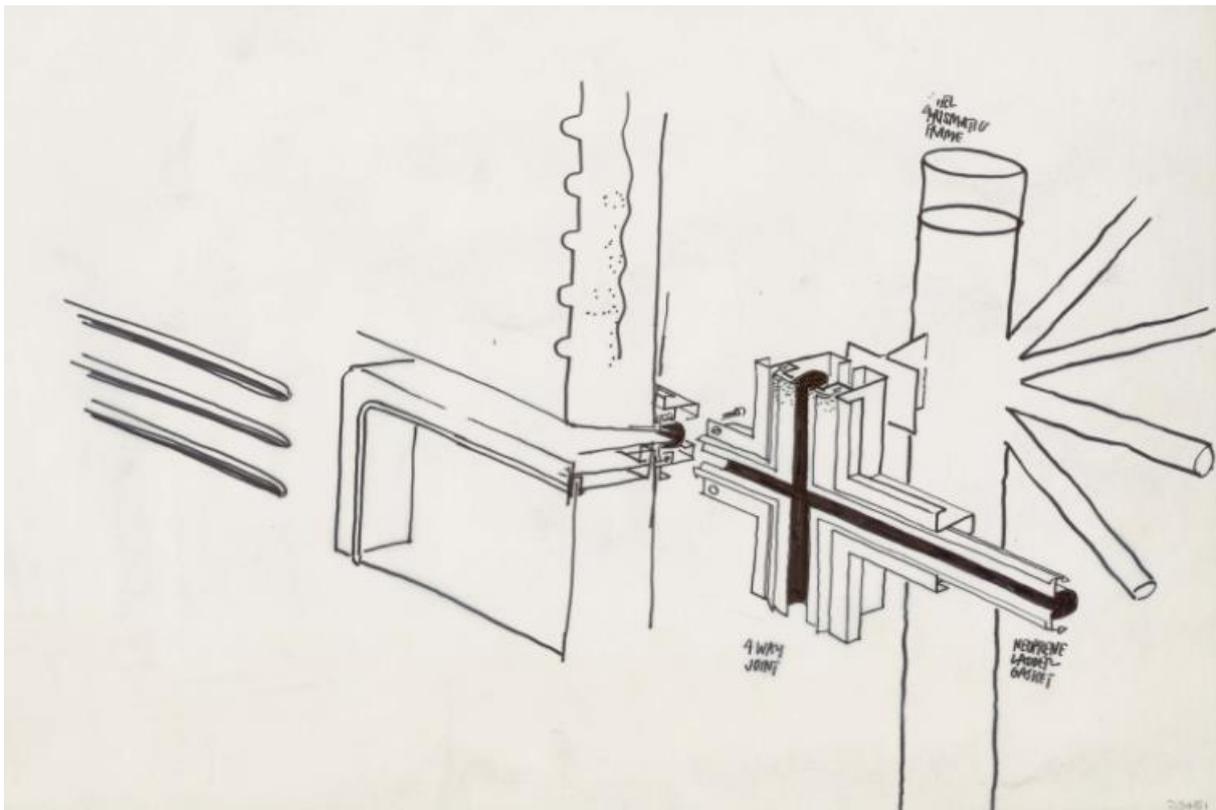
Detalle del sistema constructivo (Norman Foster Foundation. (2017). Detail [Ilustración]. Norman Foster Foundation Archive.
